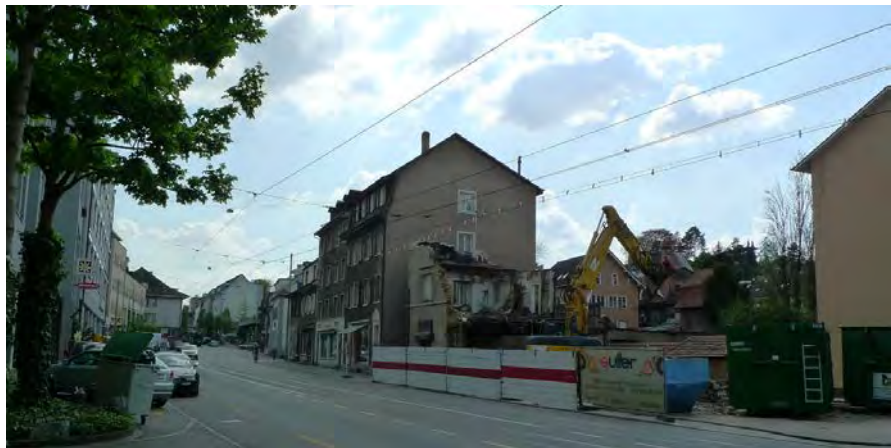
Gebäude Hauptstrasse 10 (Abbruch) und Hauptstrasse 12/14
